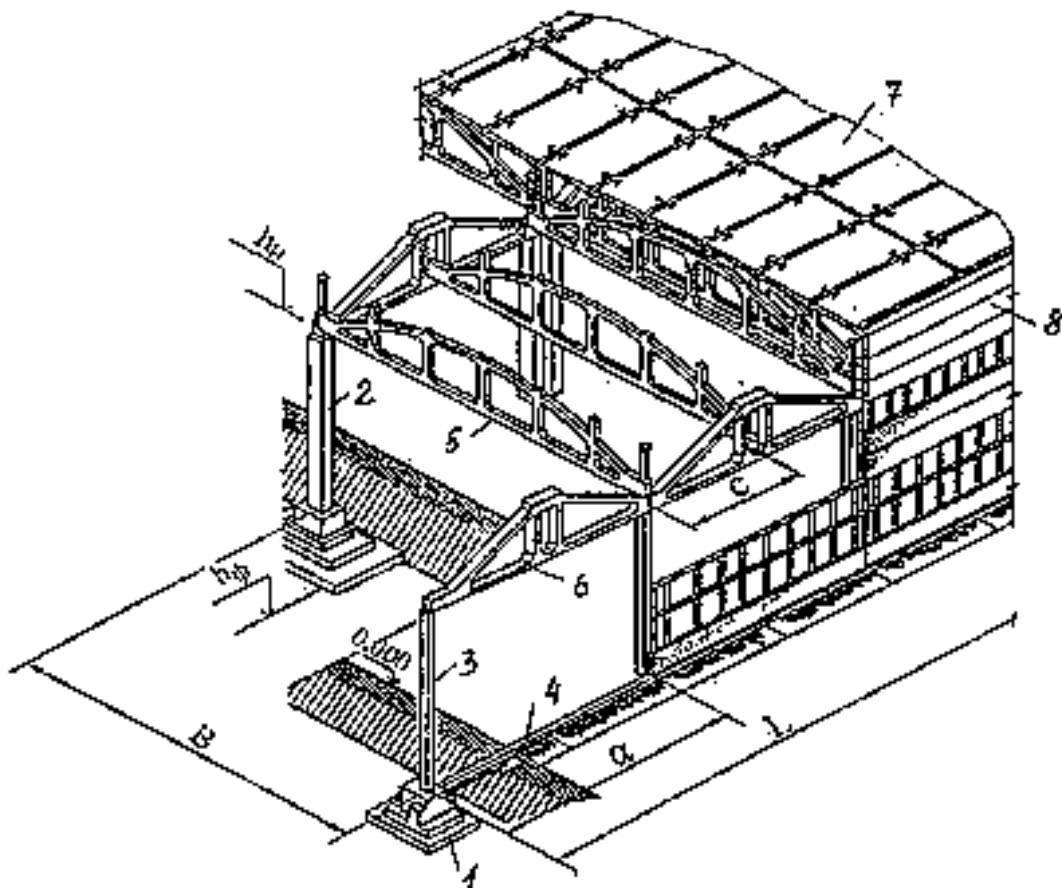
Одноэтажное промышленное здание из сборного железобетона
